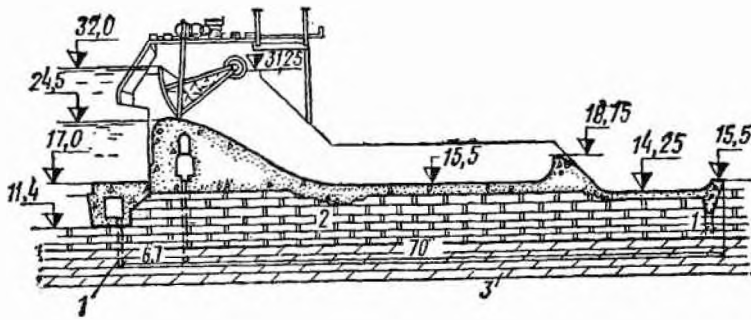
Поперечный разрез водосливной плотины Кегумского гидроузла
